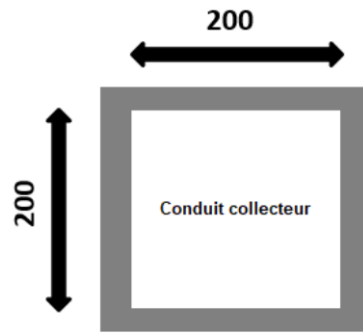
Schéma en coupe d'un conduit de fumée Shunt comprenant un conduit de ventilation dédiée
